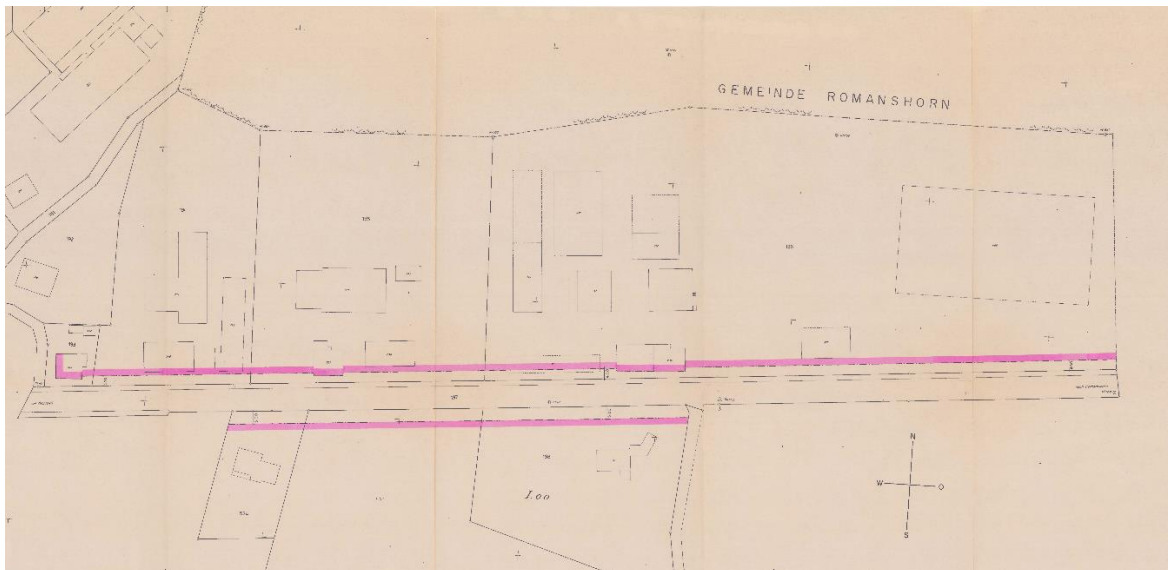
Ausschnitt des Baulinienplans längs Staatstrasse Hatswil Ost
